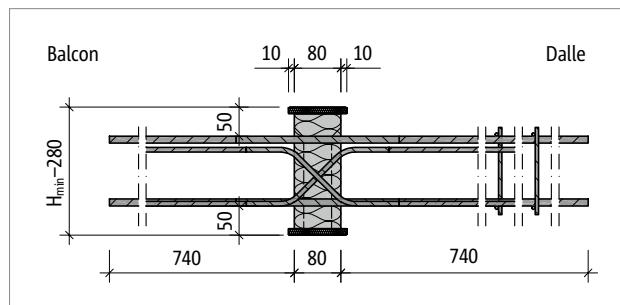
Schöck Isokorb® T types D-MM1-VV1 à MM5-VV1 à CV50 : coupe du produit
